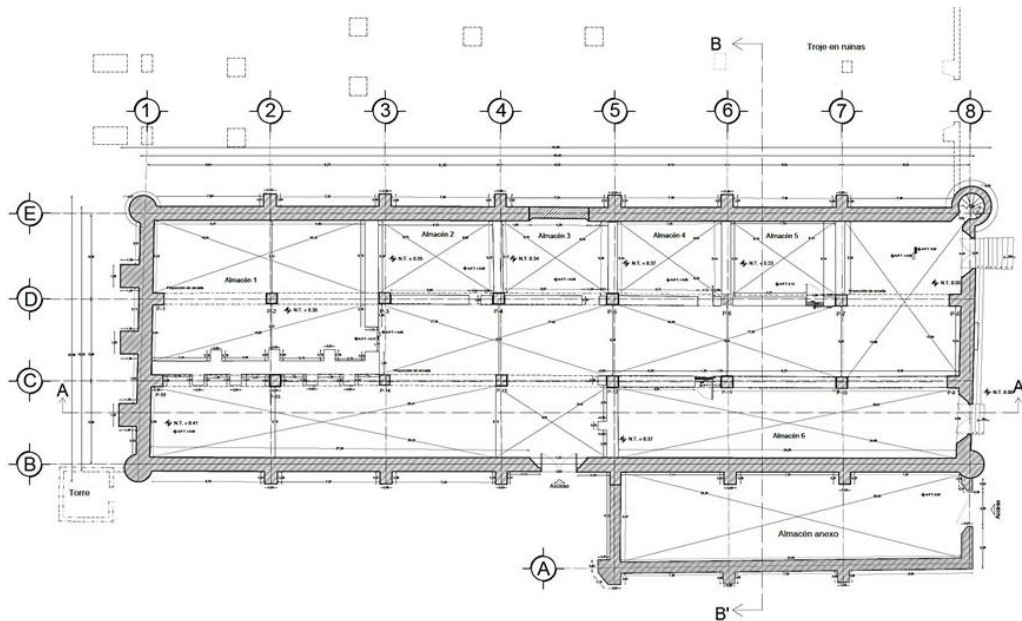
Planta arquitectónica de la troje en la Hacienda de Mezquite Gordo
